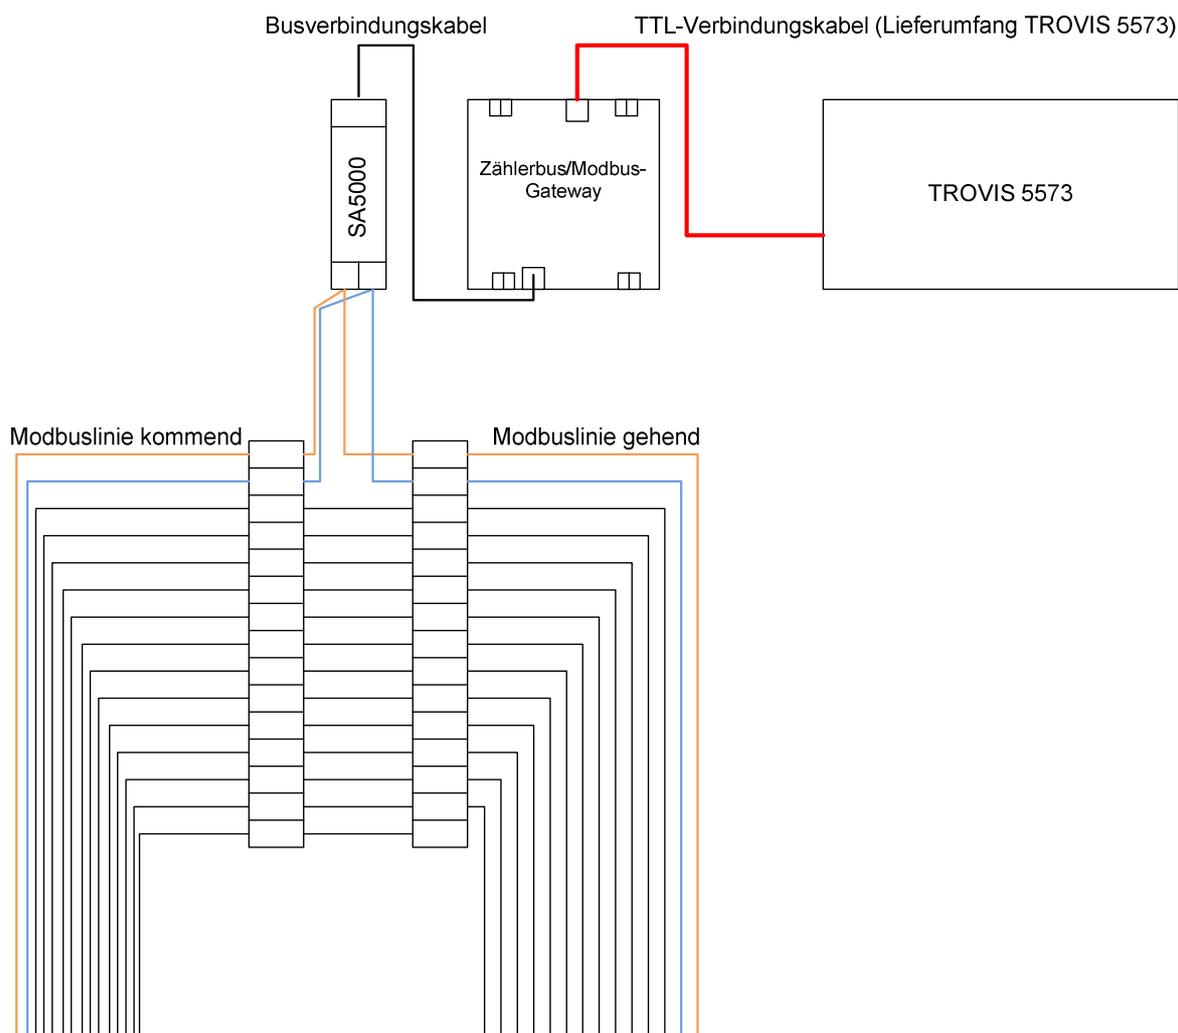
Verdrahtung einer Hausstation in der Linienstruktur
